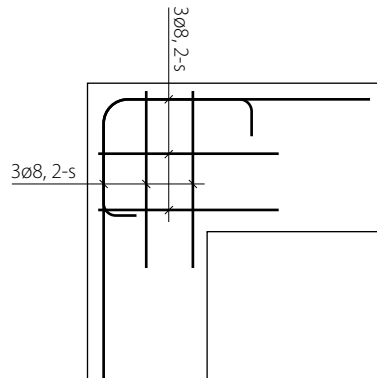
Bewehrungsführung für negative Momentenbeanspruchung
